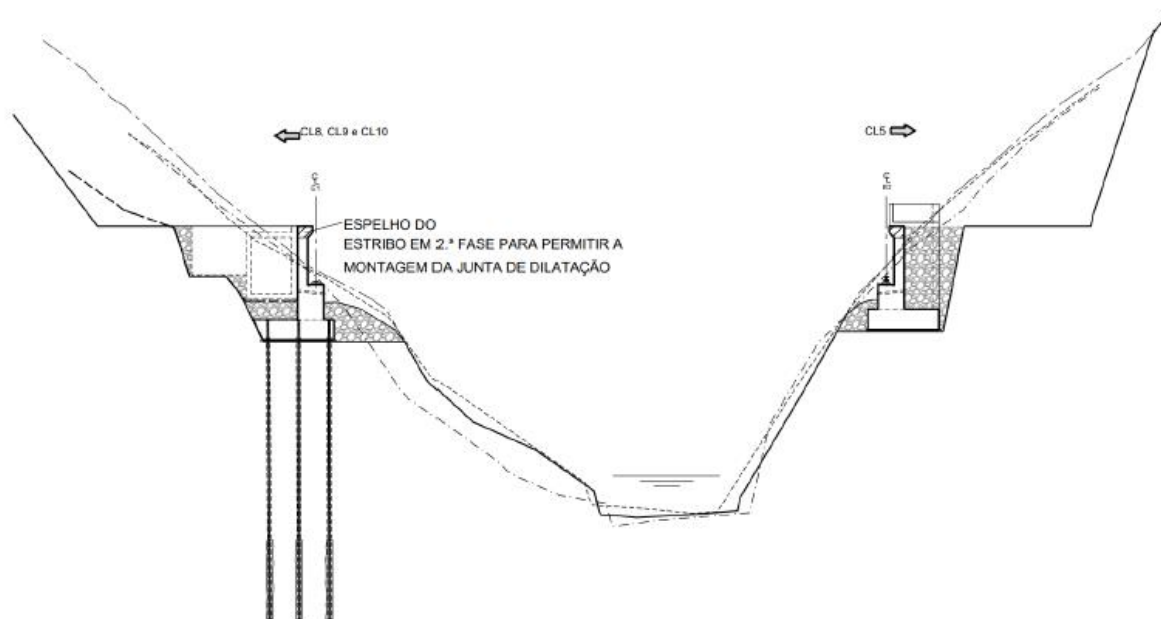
Fase III: Execução de aterros e preenchimento das escavações provisórias
